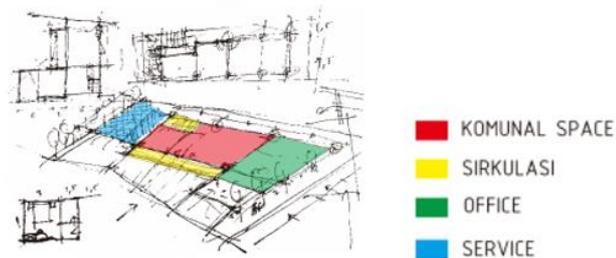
Skema Site Plan Rumah Tahfidz
